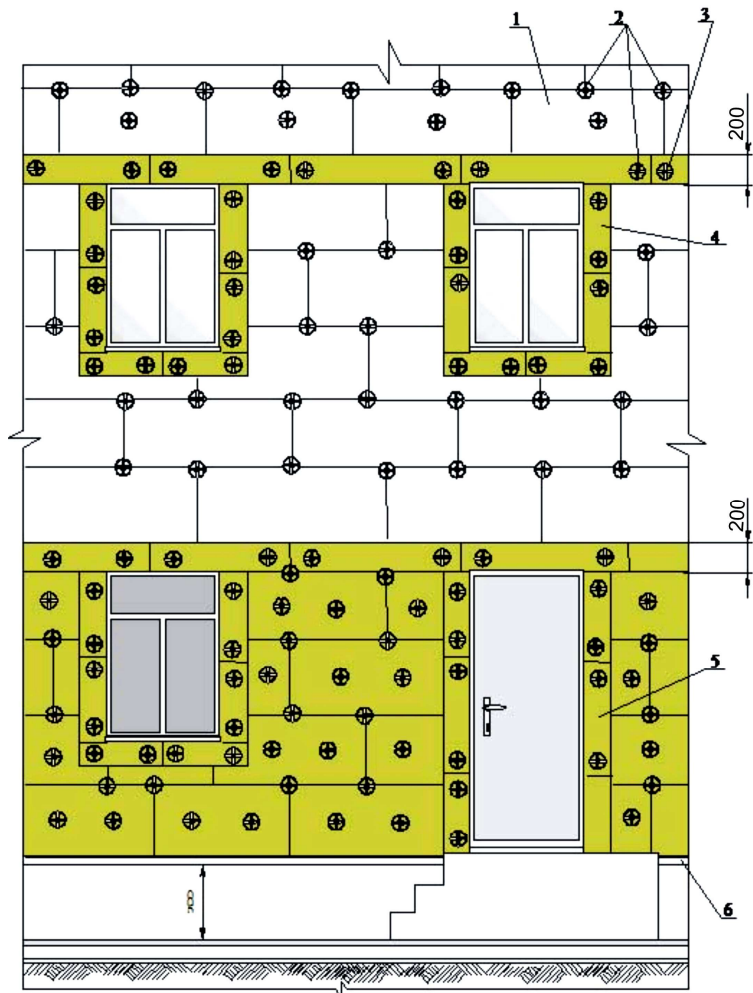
Размещение противопожарных рассечек и нижнего пояса на участке фасада здания.
